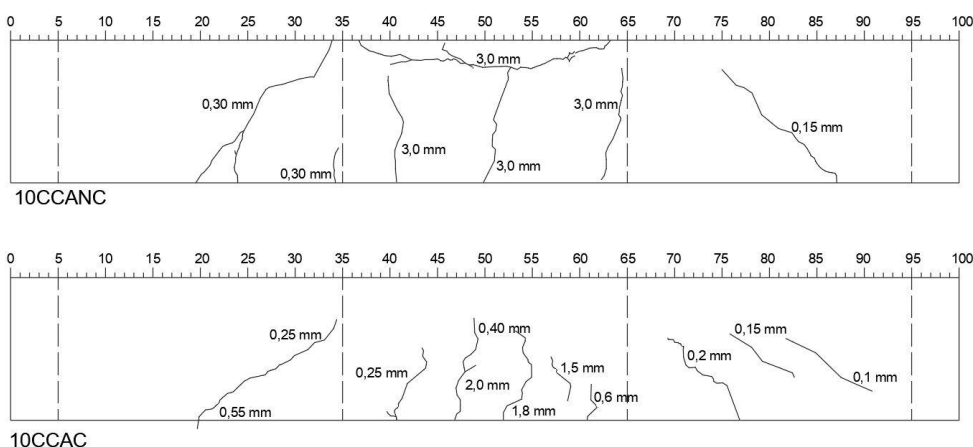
Mapeamento de fissuração vigas referência
